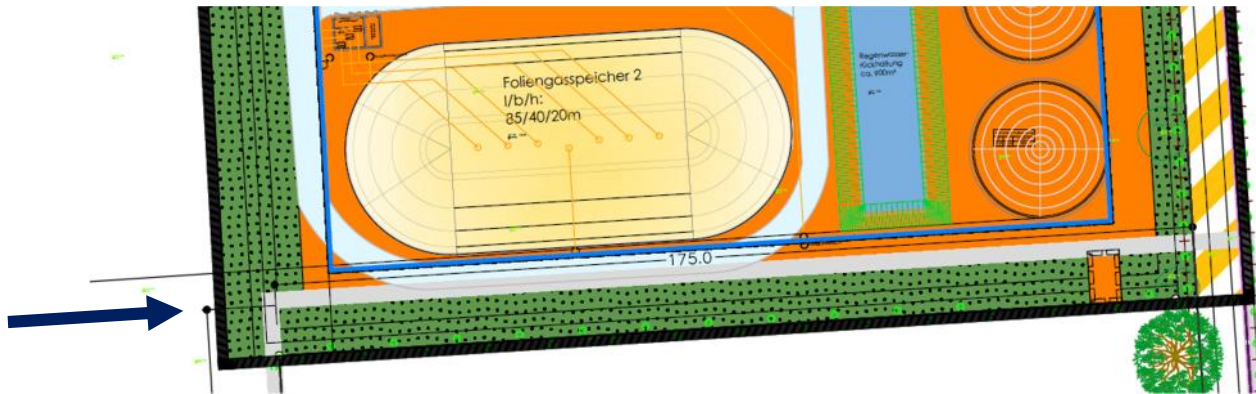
Ausschnitt Planentwurf Bebauungsplan Nr. 130 mit Planungskonzept
